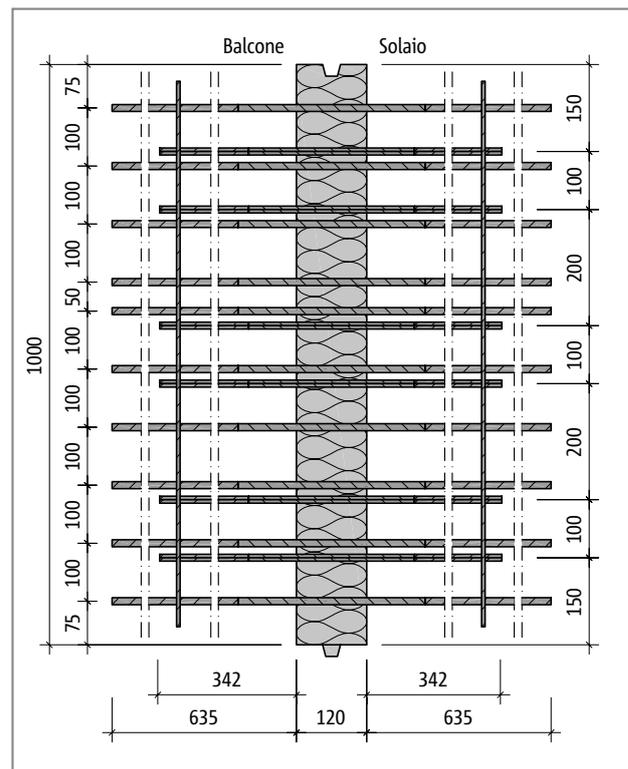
Schöck Isokorb® tipo DXT70-VV6: pianta
